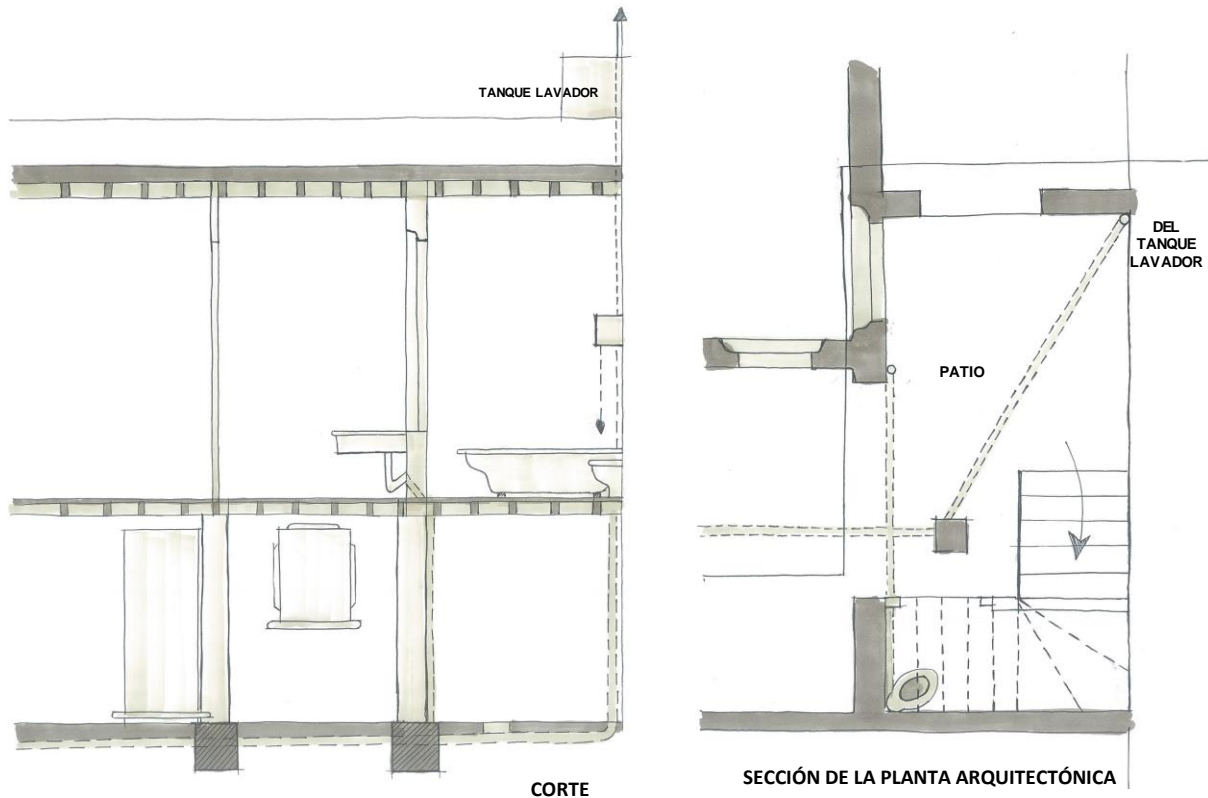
y 43. Detalle en corte y planta de la colocación de un tanque lavador en una casa habitación.
